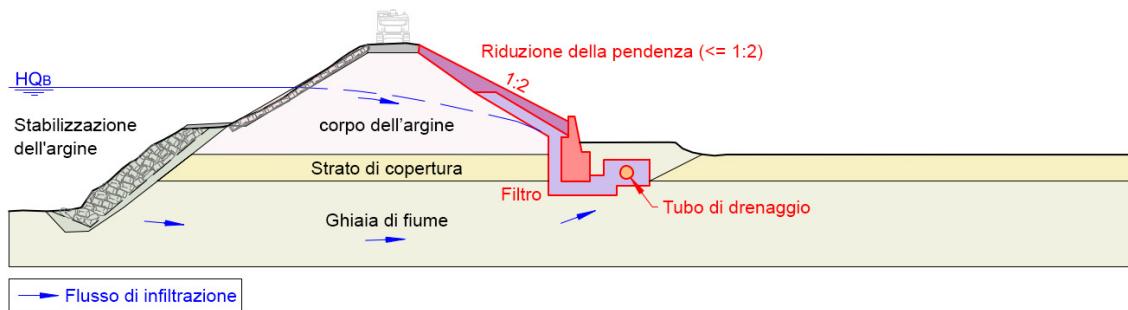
Sezione trasversale tipica di un argine nel caso di risanamento con un muro di sostegno (strato filtrante in viola).
